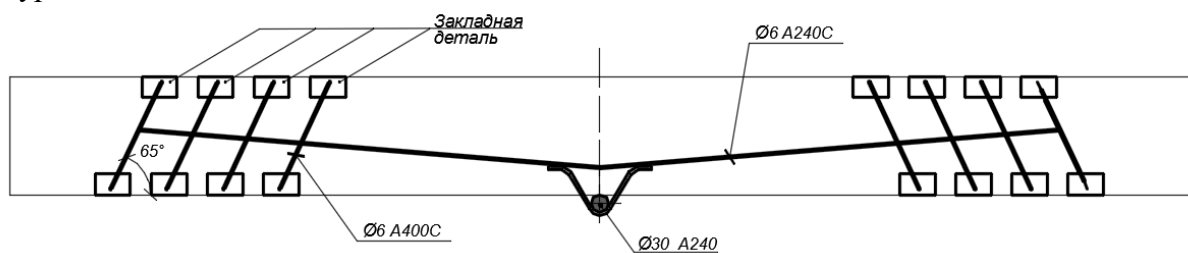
Схема підсилення балки БПП-II-1 поздовжньо-поперечною зовнішньою системою арматурних стрижнів.
